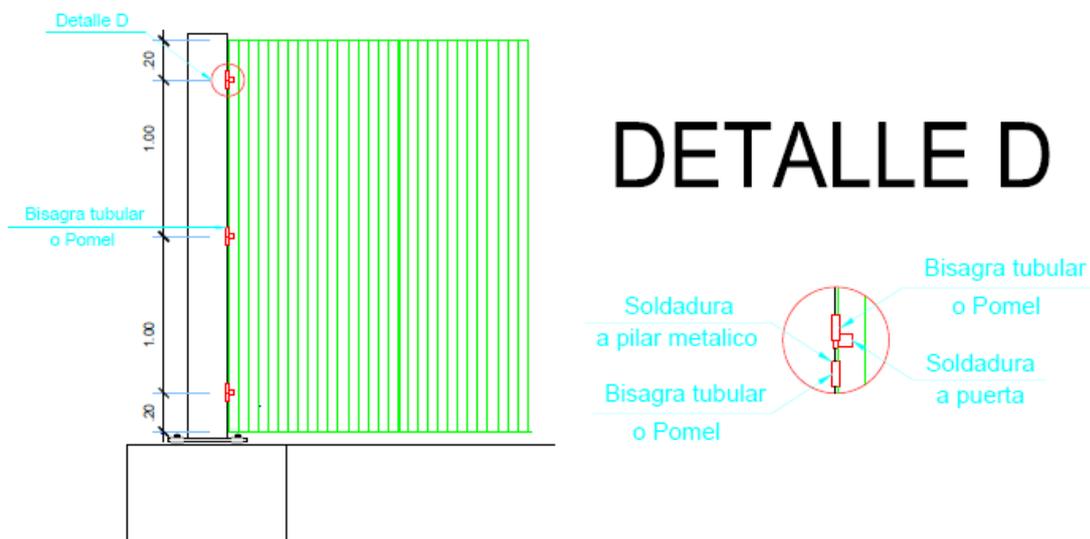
Detalles de anclaje para puerta batiente en perfil metálico.
